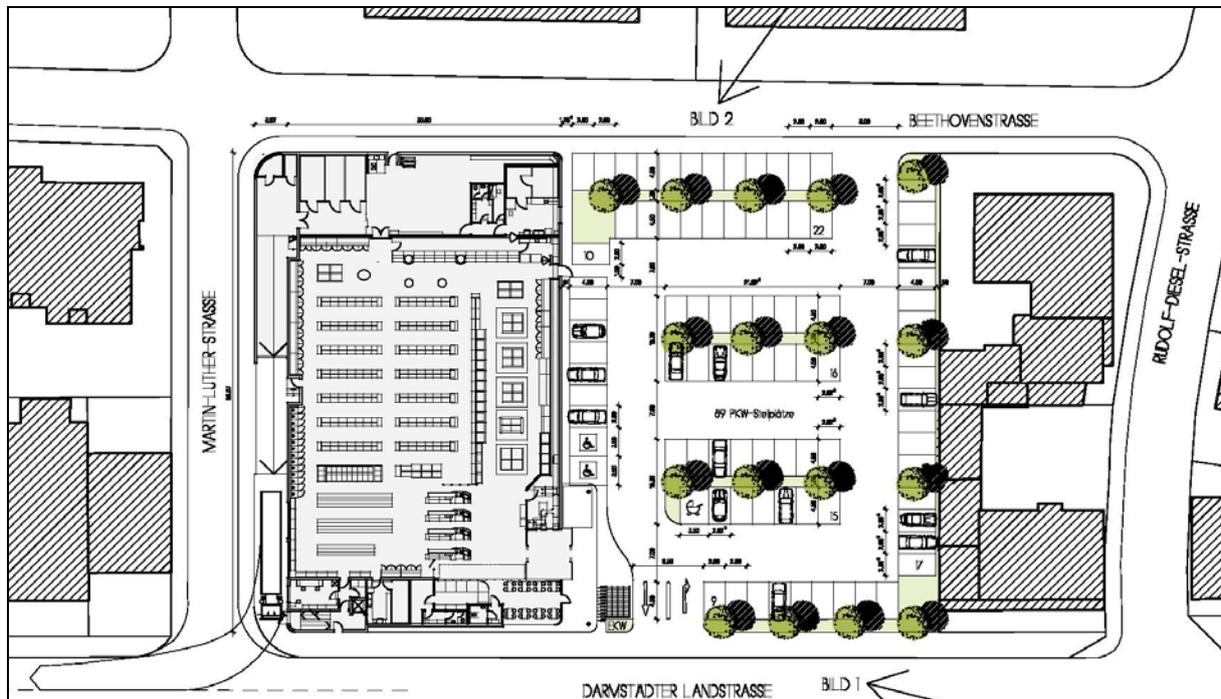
Lageplan des geplanten Einkaufsmarktes ⁴
